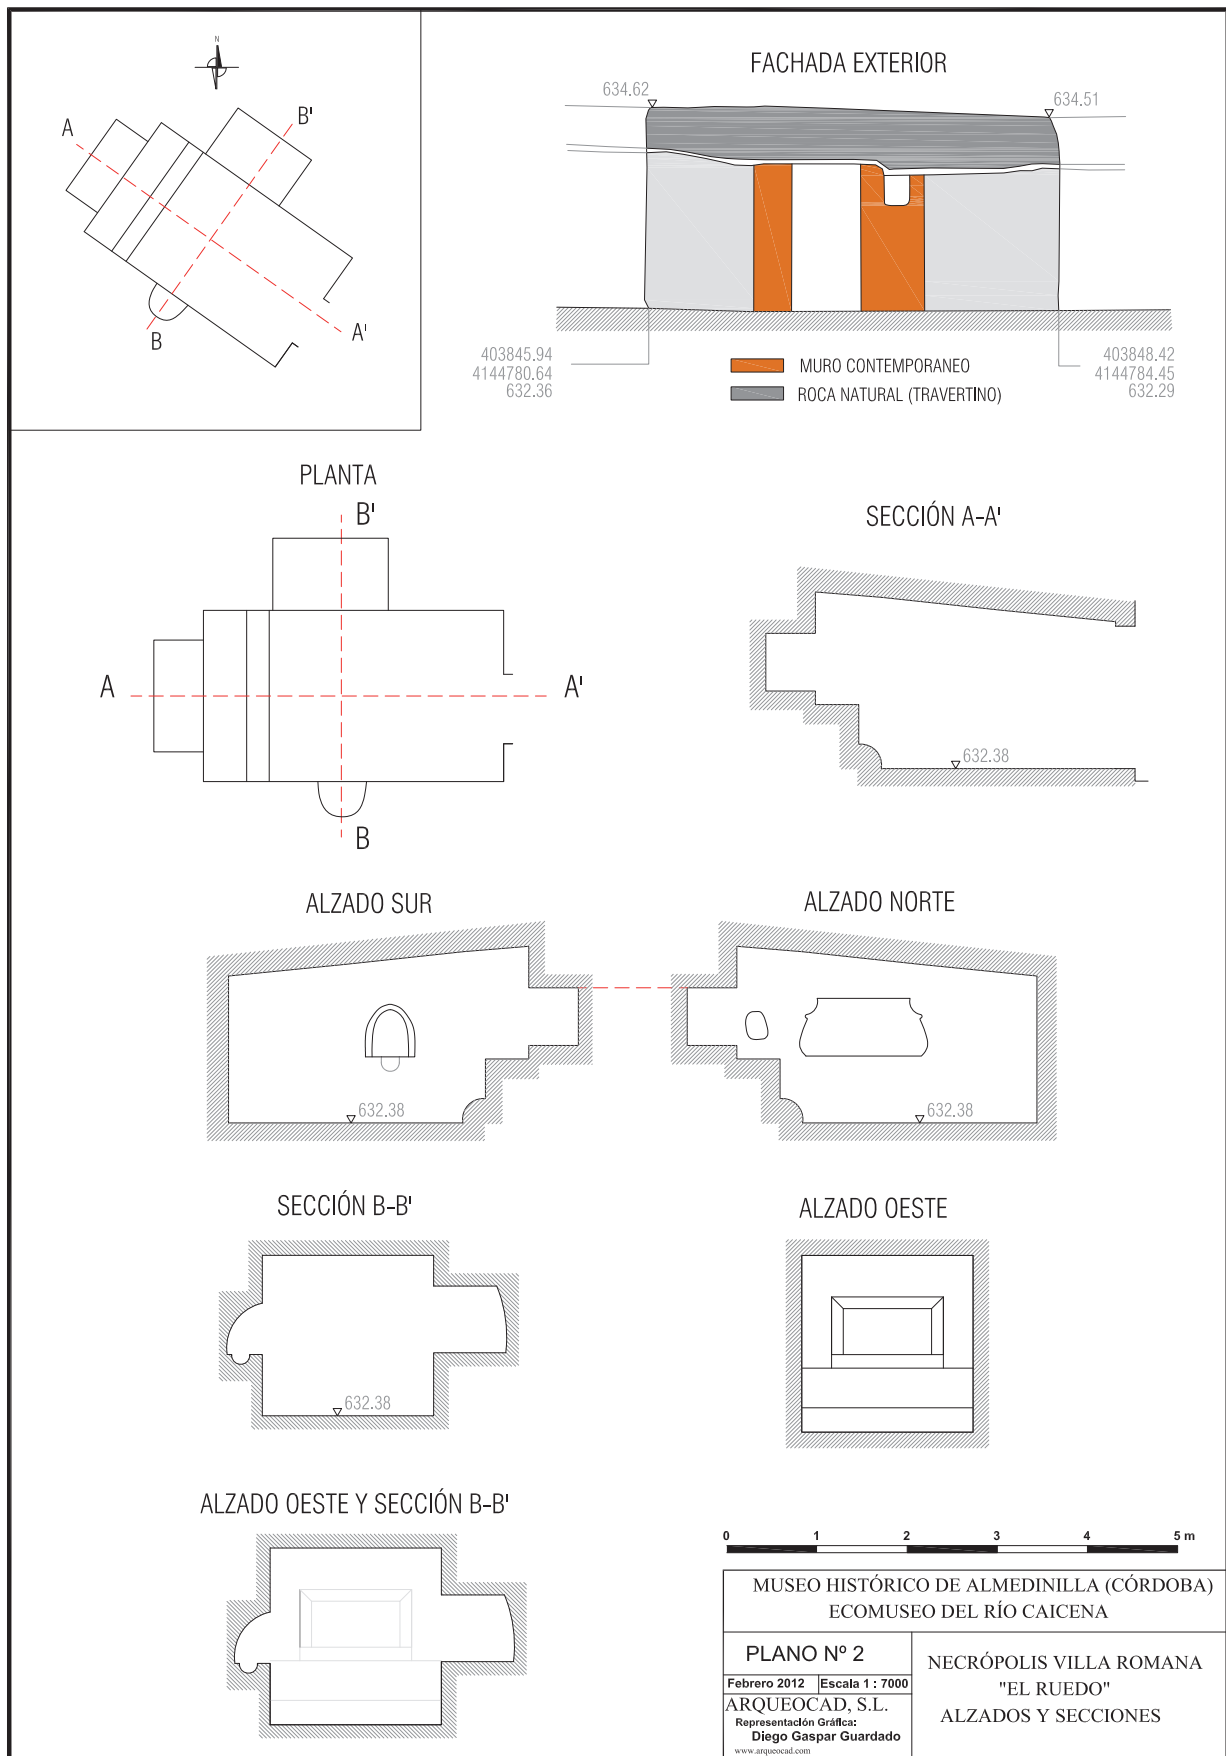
Planta, alzados y secciones de la tumba-hipogeo.
